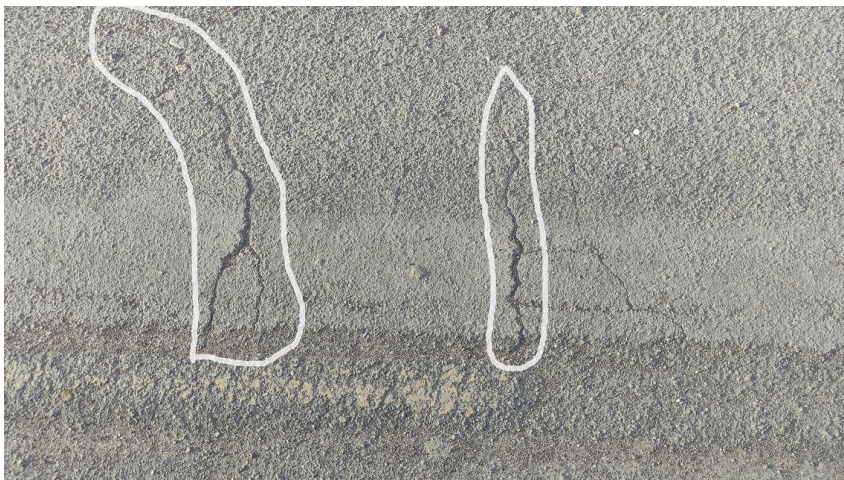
Se presentan los daños por grietas longitudinales y transversales con mayor severidad en la calzada derecha en la U/M 02 de la vía TA-104 del km 2+000 al 3+000, región de Tacna.
